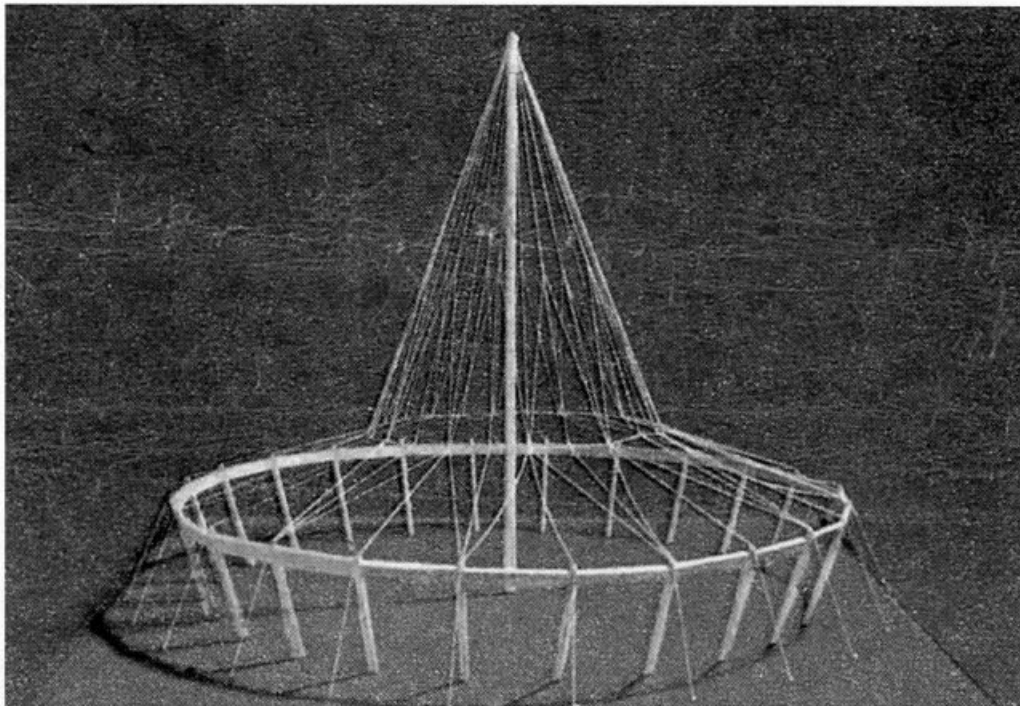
Vue sur une maquette structurale du pavillon de l'île Maurice
